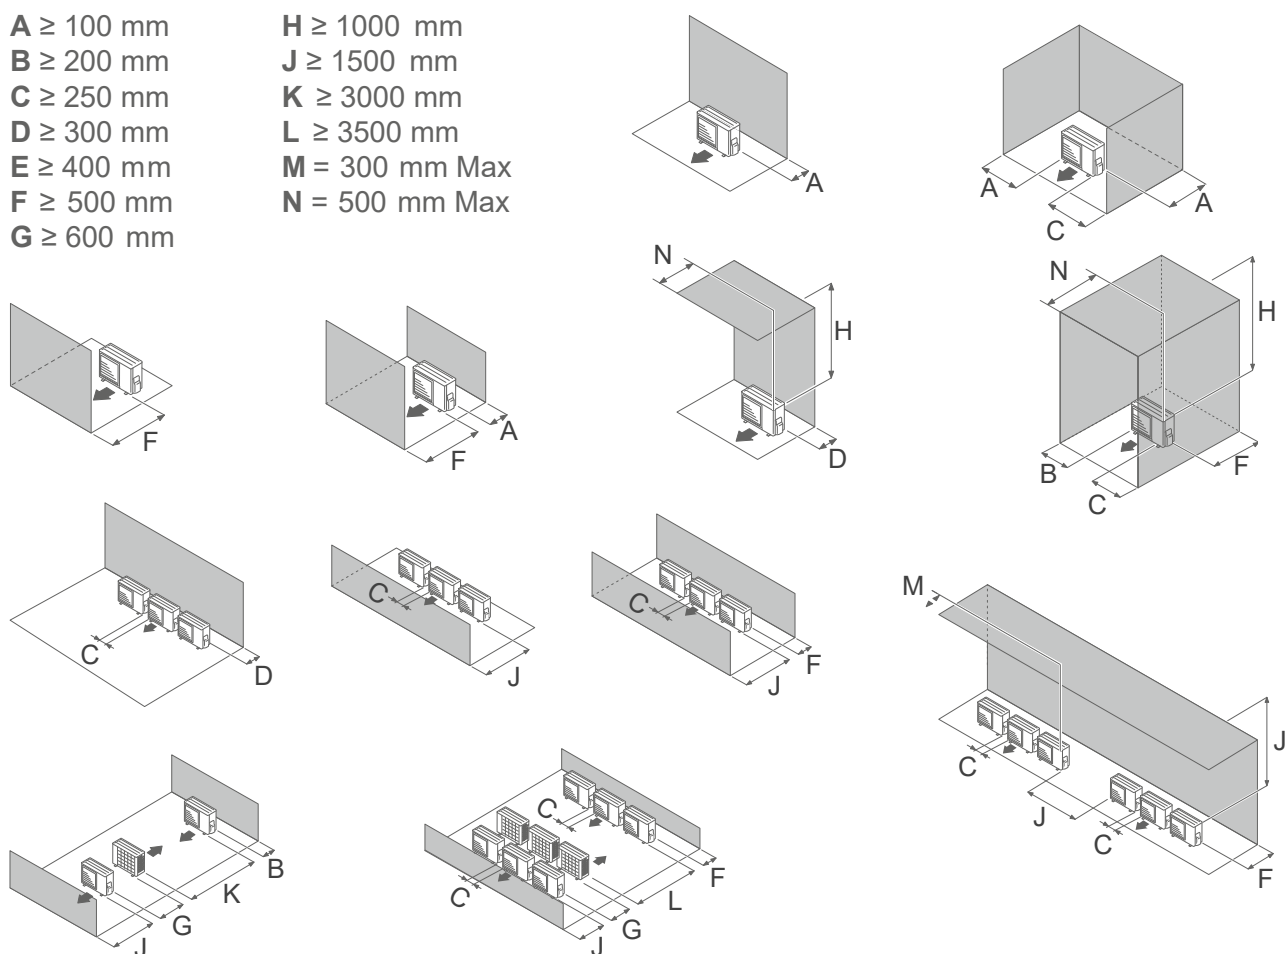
Minimale installatieruimte rond de buitenunit voor gebruik buitenshuis
